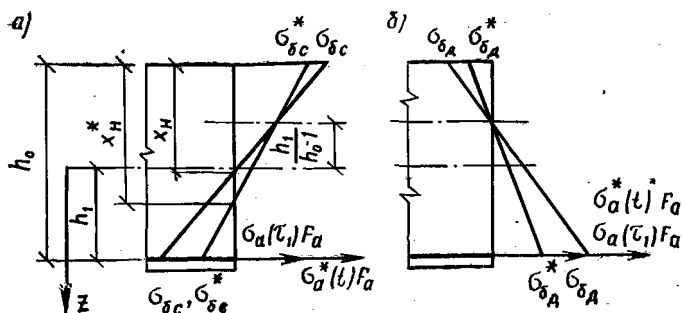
Эпюры нормальных напряжений в поперечном сечении железобетонного стержня
